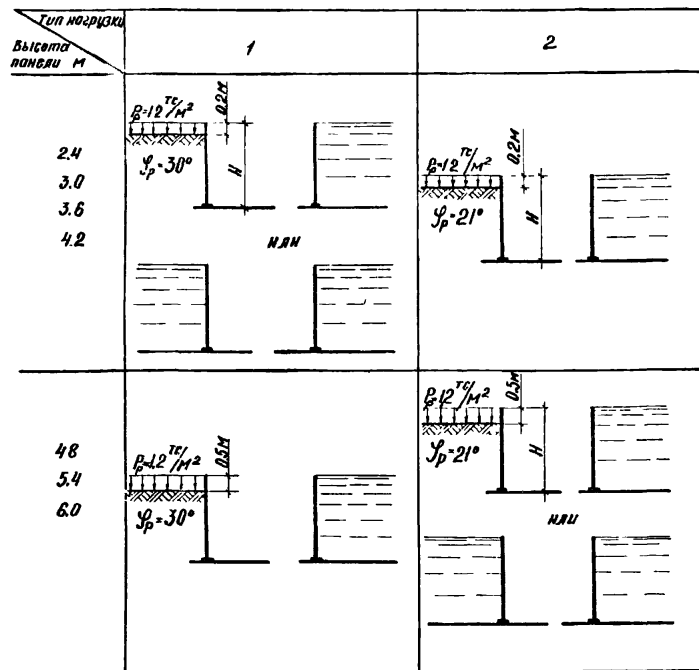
Схемы расчетных нагрузок на консольные и балочные стены открытых сооружений высотой 2,4 + 6,0 м
